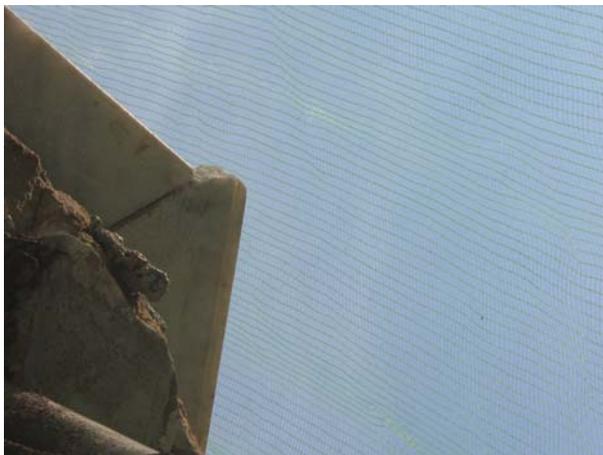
Vista da quina da varanda com pedra quebrada e junta desalinhada.
